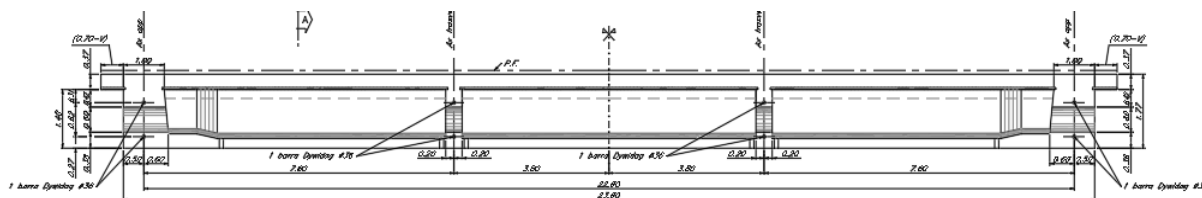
Ponte Frestola – Sezione longitudinale impalcato
